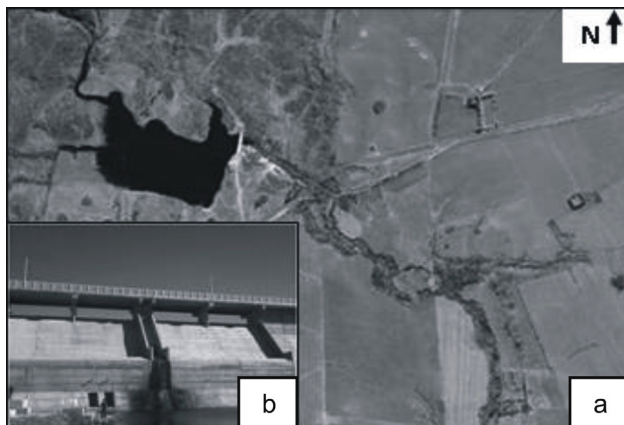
a. Vista en planta del embalse de la presa Achiras. b. Vista de la presa
